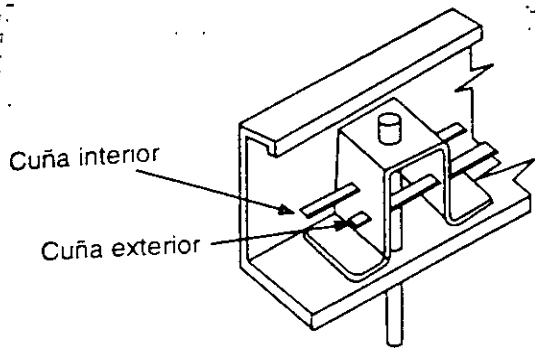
Detalle del arriostamiento, cuñas y pasadores en cimbra fija.
